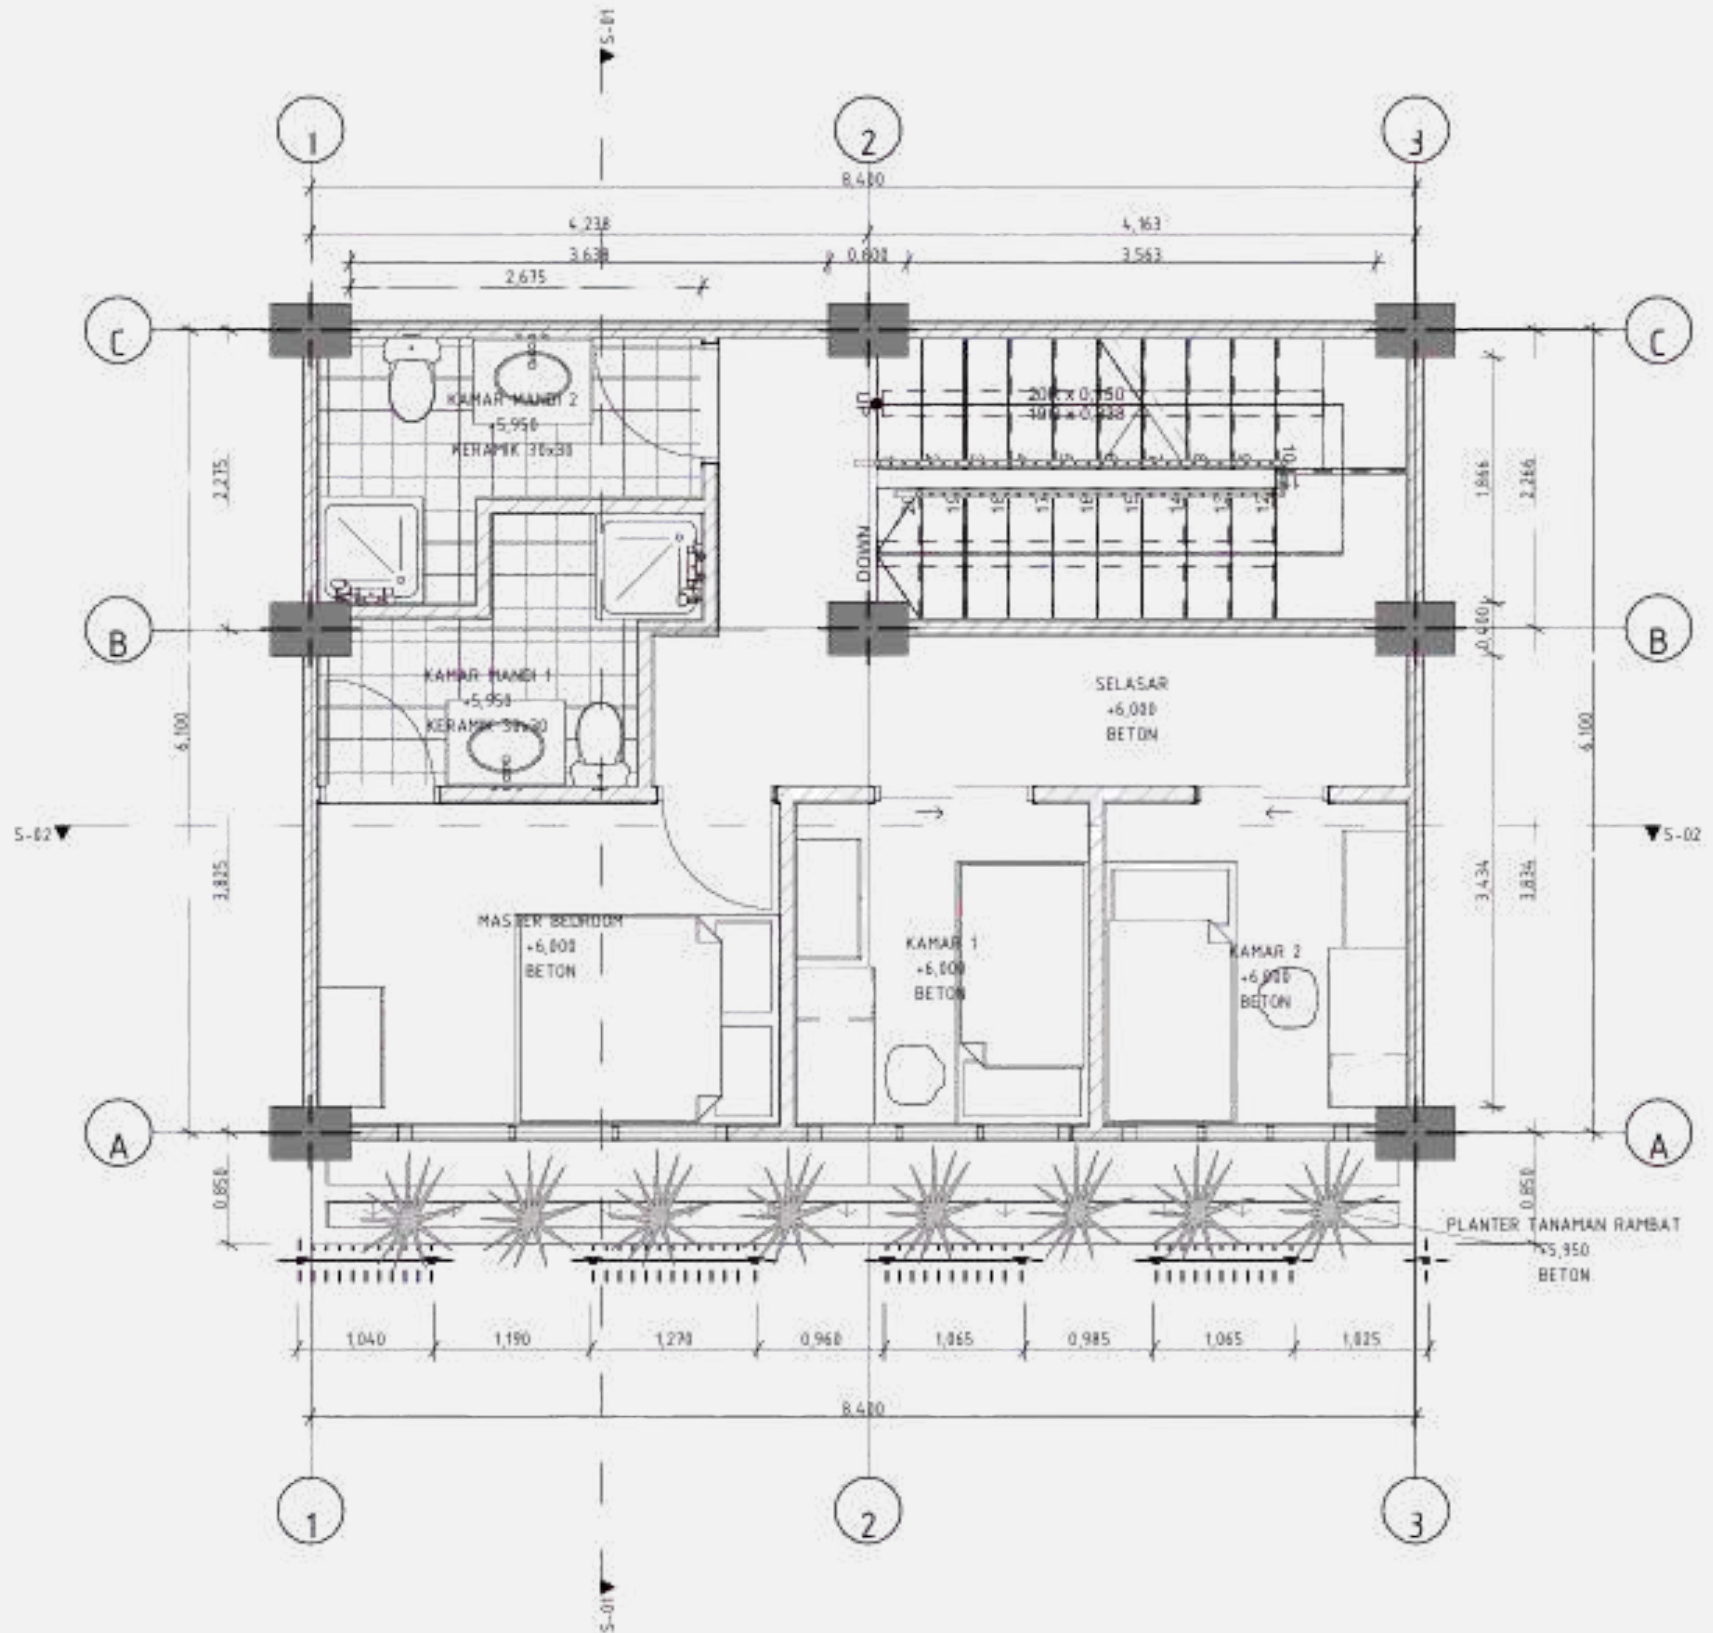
Denah Ground Floor Unit Tipe 54
